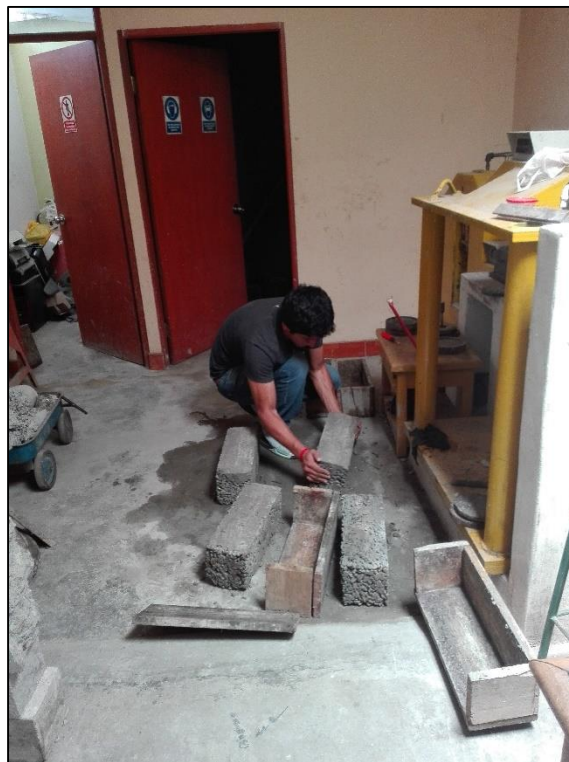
Desmoldado de viguetas de concreto permeable.
